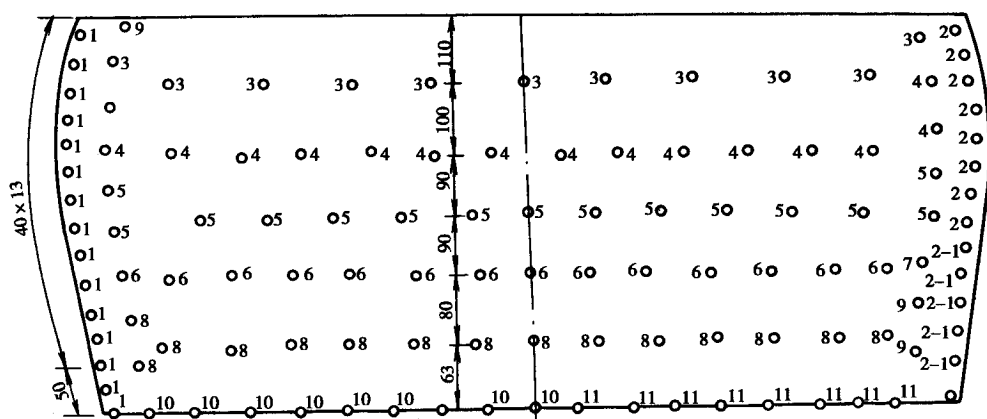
下半断面炮眼布置图(尺寸单位:cm)
